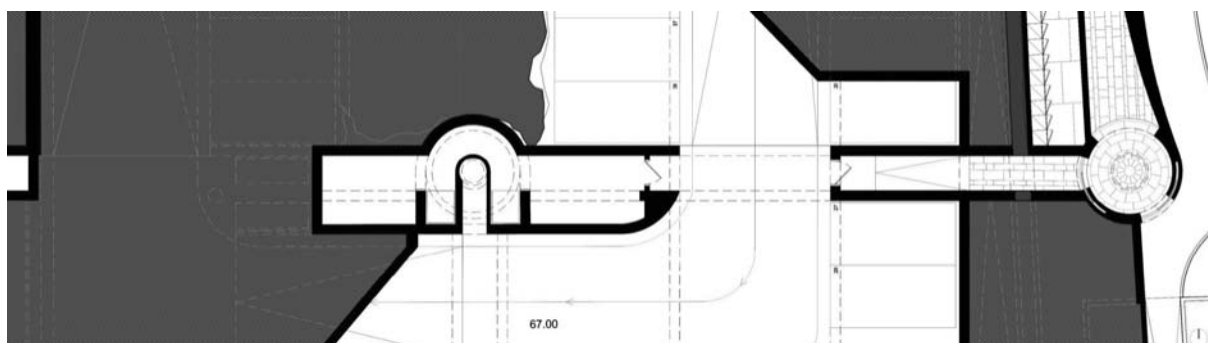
POR. 1 - Planta de piso térreo e túnel: Corte cota 68.50.
